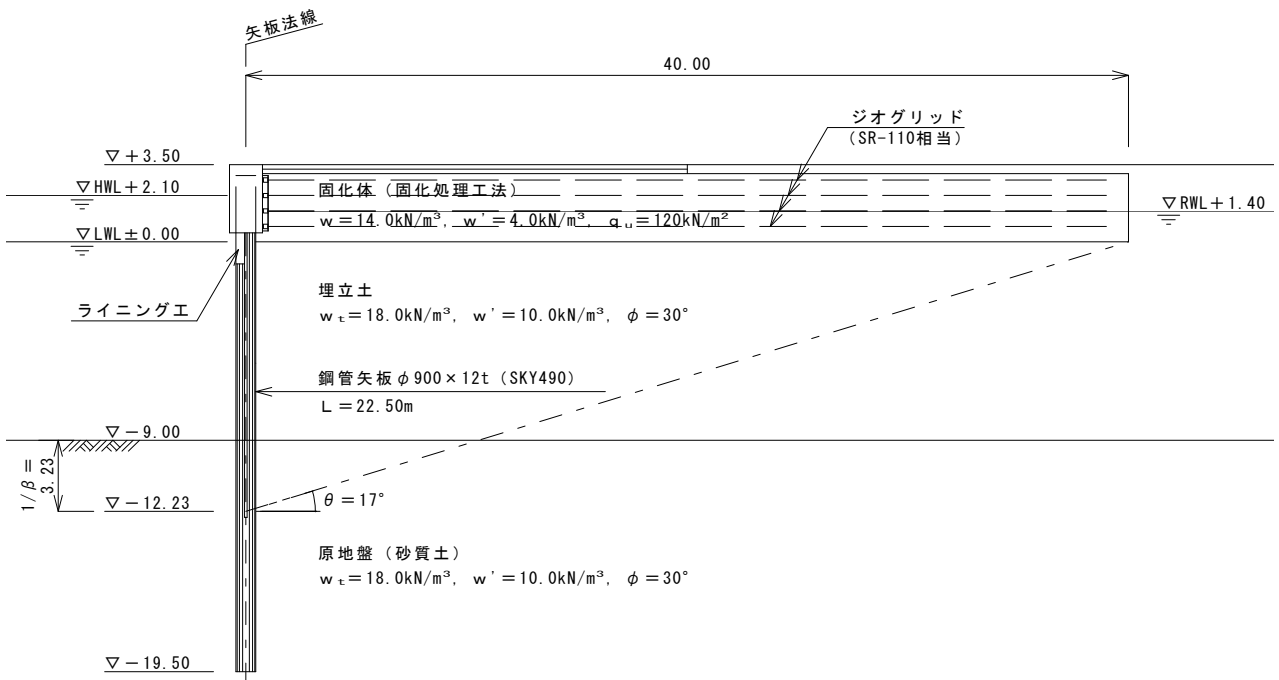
SG-Wall 式矢板岸壁標準断面図
